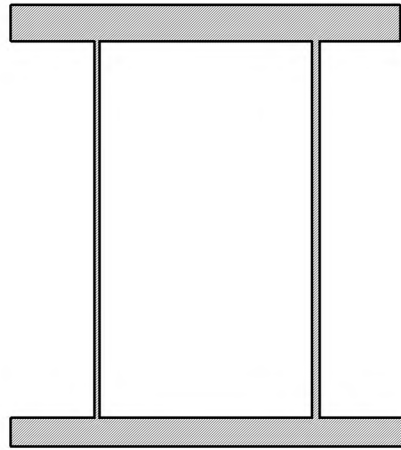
Побудова стін і перегородок фрагмента будівлі
